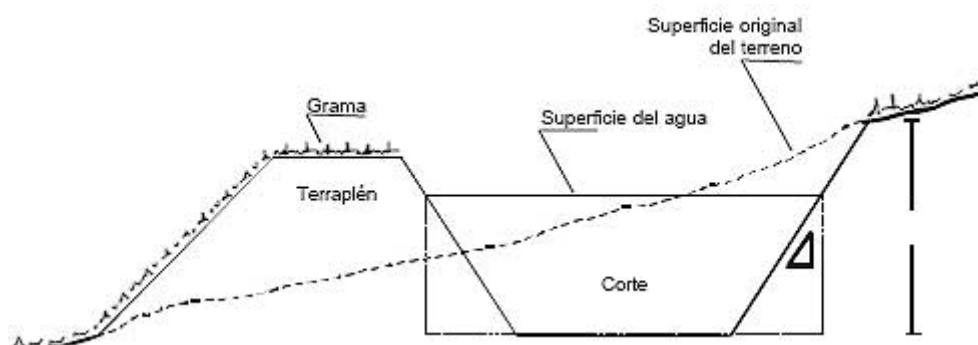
Detalle de la sección transversal del canal trapezoidal.
